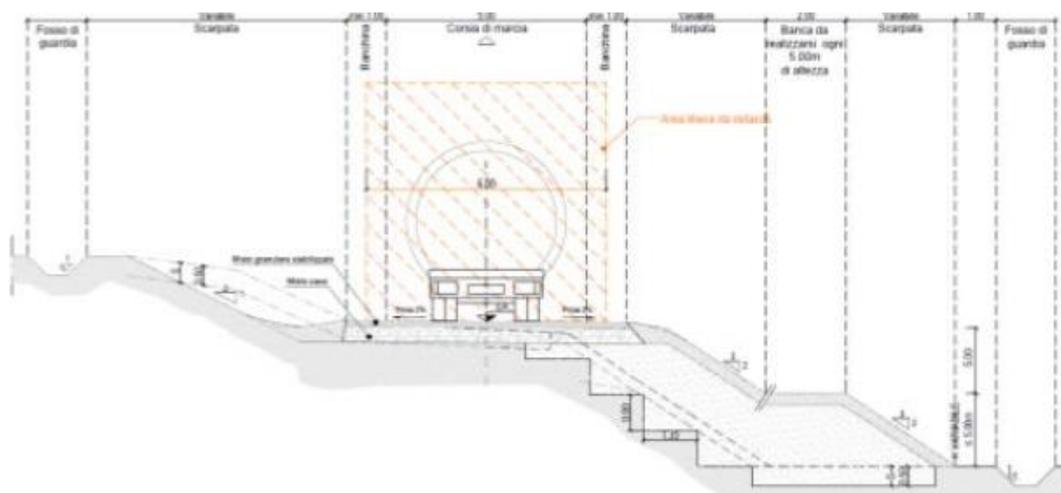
Sezione tipo in rilevato, trincea e mezzacosta
